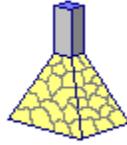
Zapata Aislada, Mampostería, Cuadrada, Sección Variable, Interna
